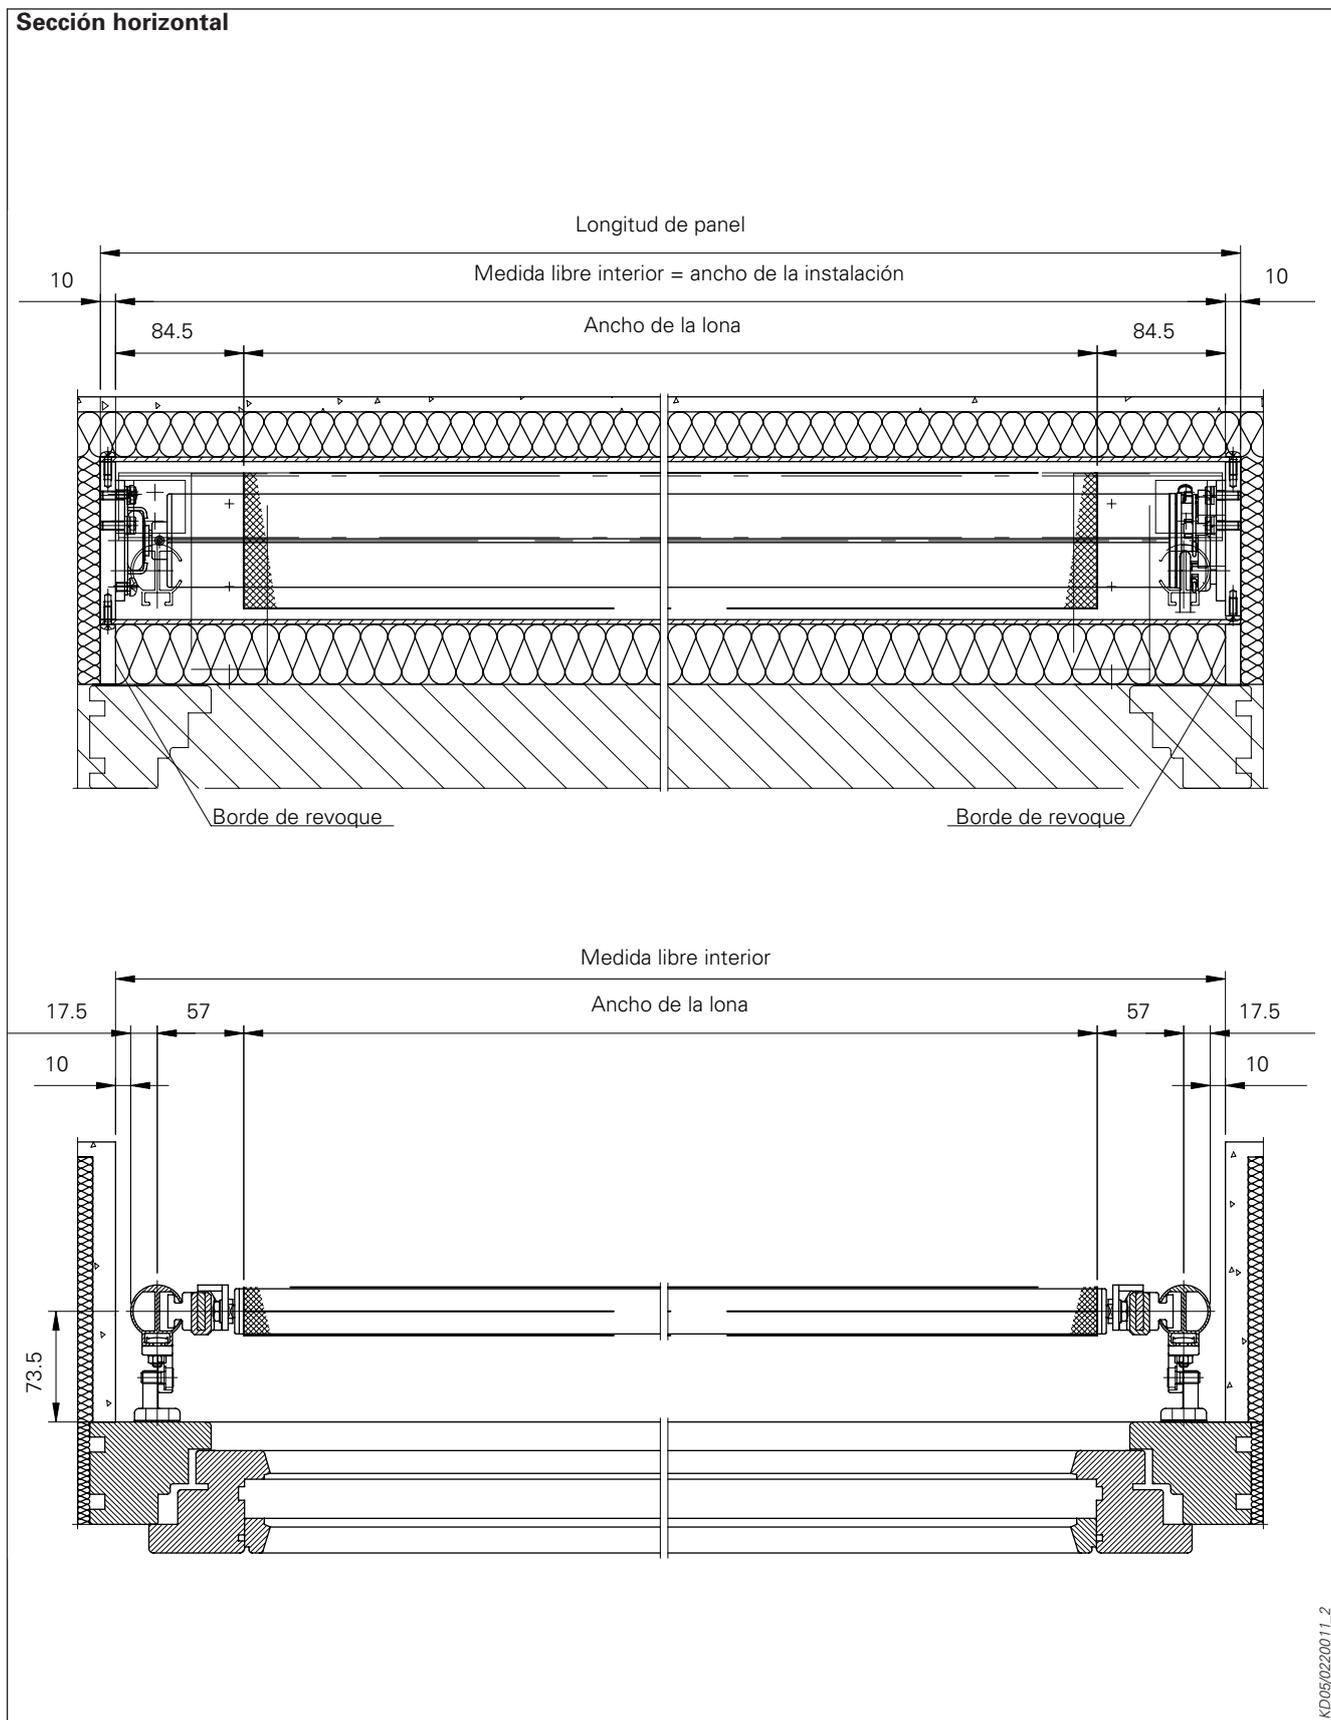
Sección horizontal marquisoleta Modelo 109 E con carril redondo Ø35 en fachada con aislamiento térmico
